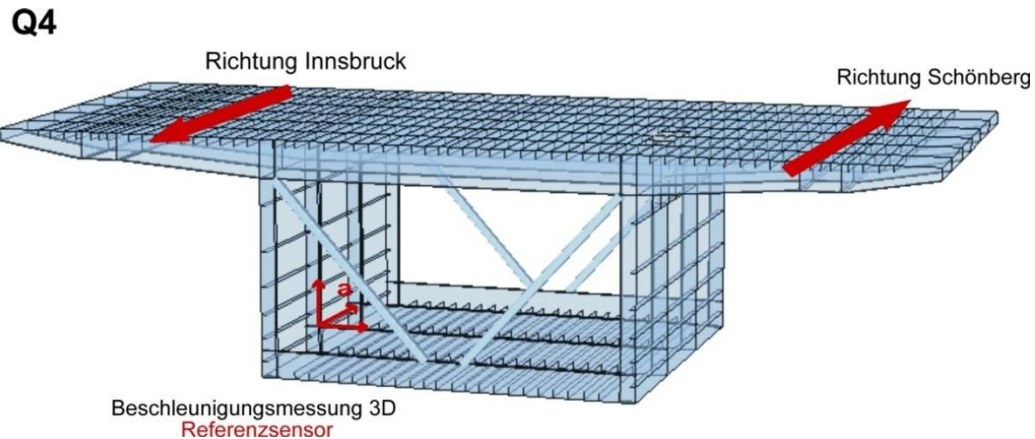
Der instrumentierte Messquerschnitt Q4 im Brückenmittelfeld (Hauptfeld)
